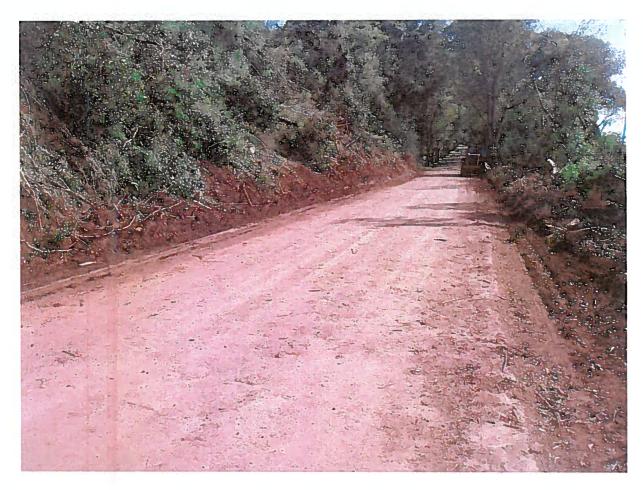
Ponto 2. Vista da pista já limpa, onde ocorreram os deslizamentos. Não foi observado fissuras nem deformações sobre a pista
